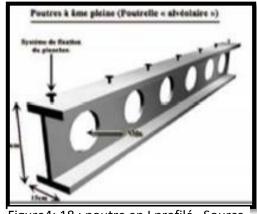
18 : poutre en I profilé , Source : concevoir et construire en acier
